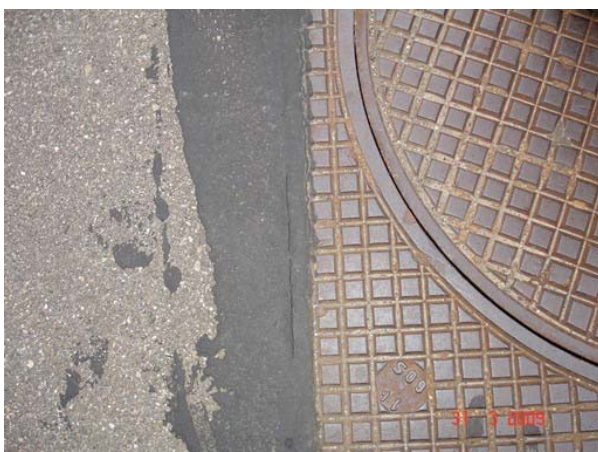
Anschlussfuge „Asphalt - Stahl“.
